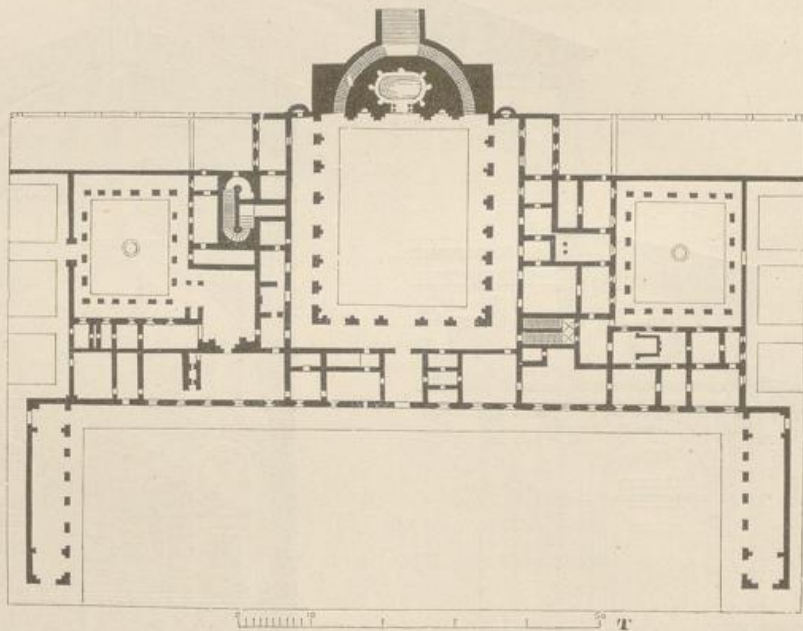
Palazzo Pitti zu Florenz. Grundriß.
